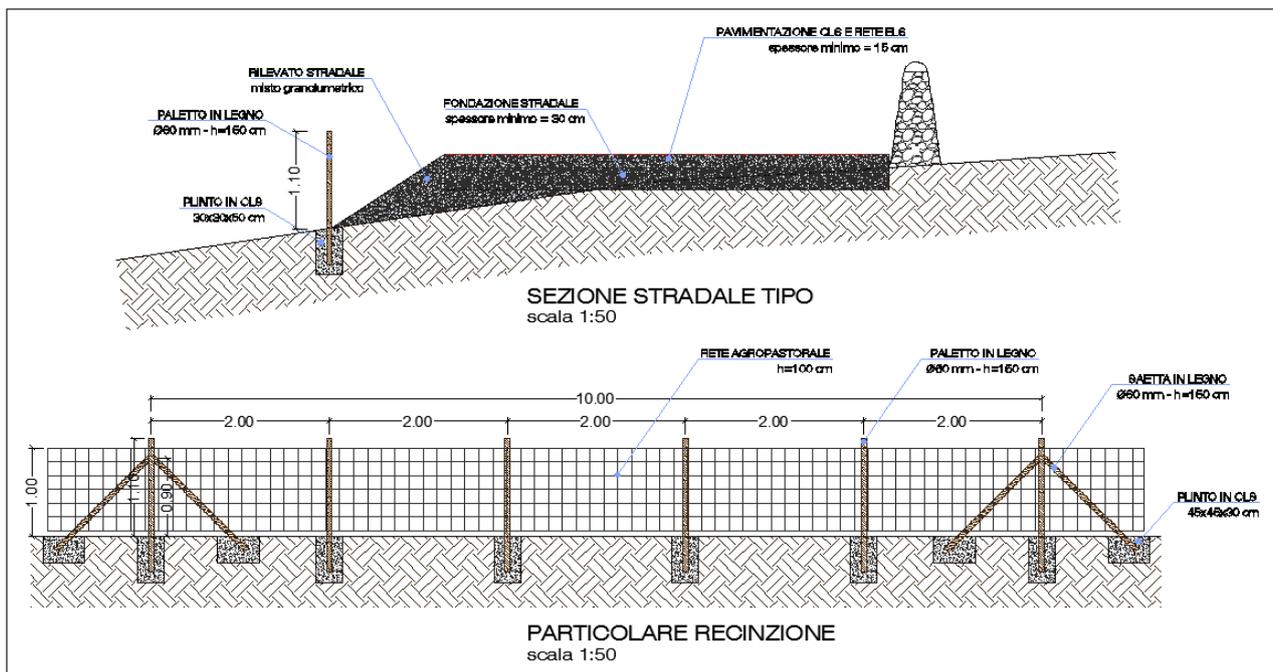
Sezione tipo e particolare recinzione strada di accesso
